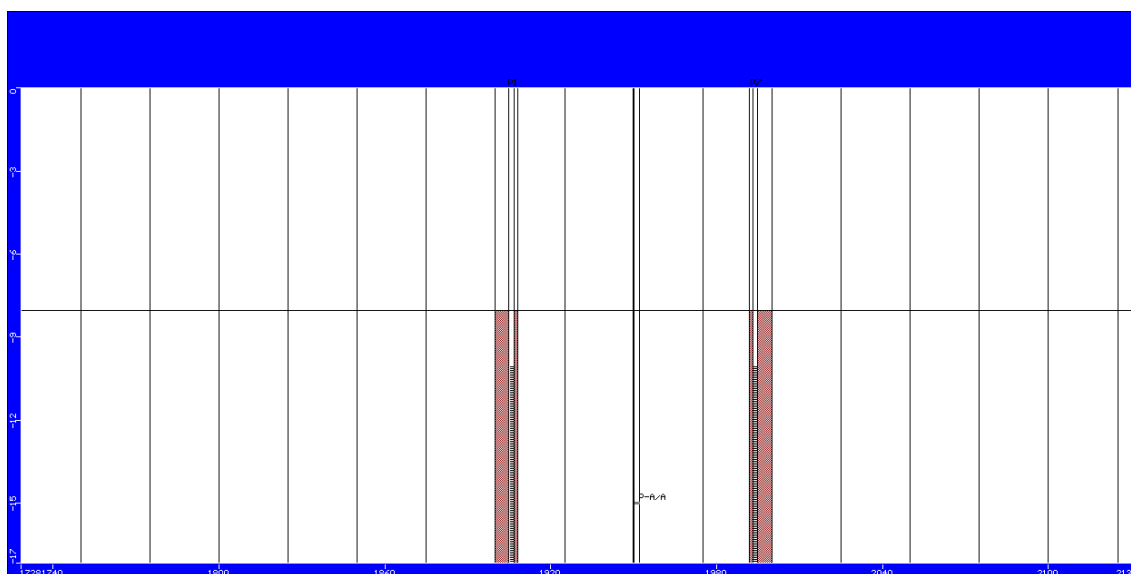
Distribución final de los pozos en alzado (centro excavación)
